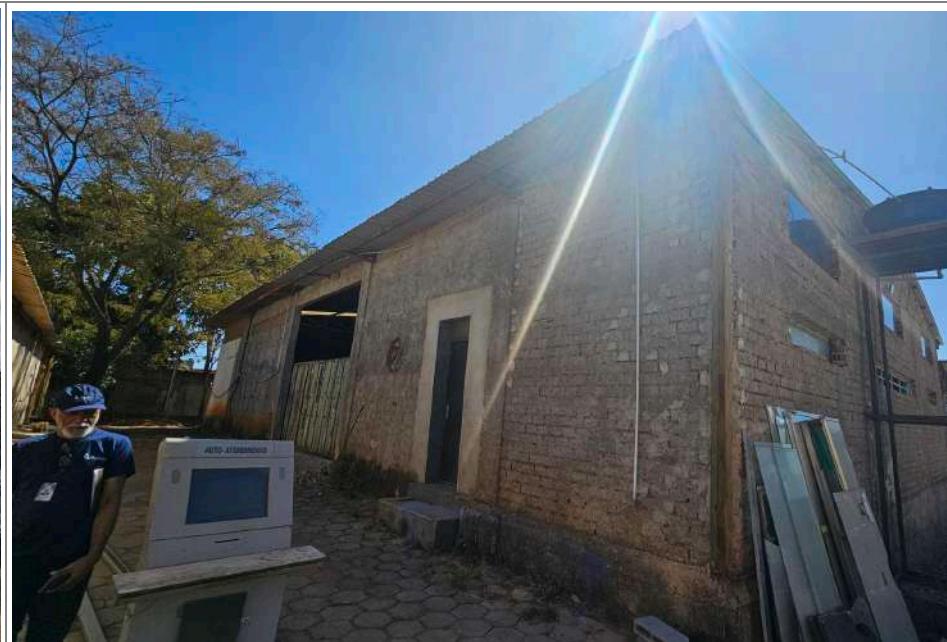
Lote 02 - Prédio compartilhado entre PMDF e Japão da Construção / Imagen 07: Edificação no lote 04-06-08 com encanamento exposto e ligação para caixa d'água.
